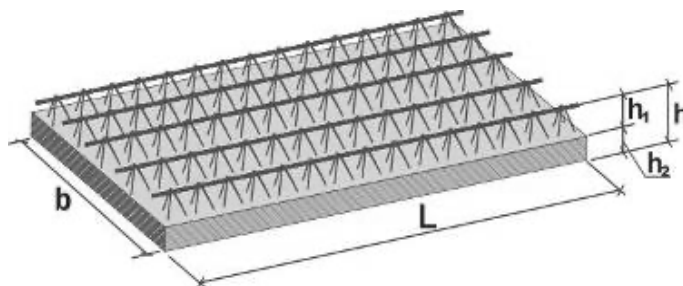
Плити опалубки з зовнішнім каркасним армуванням
